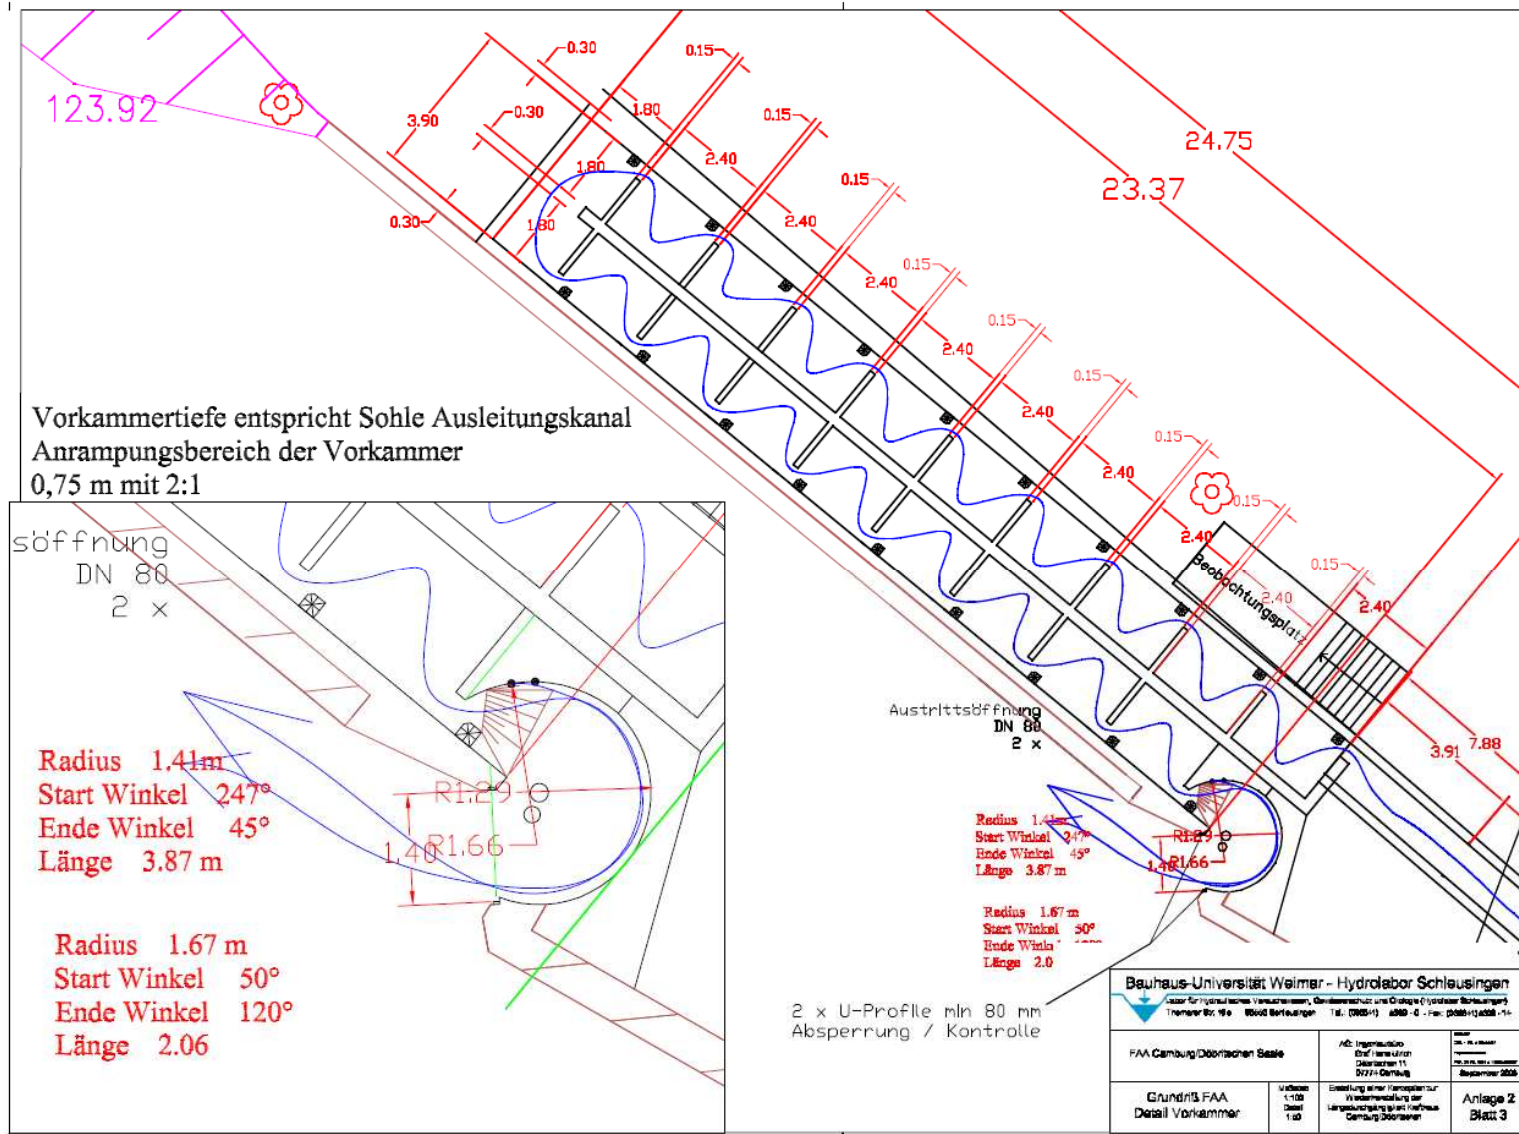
Grundriss des Schlitzpasses mit Vorbecken
